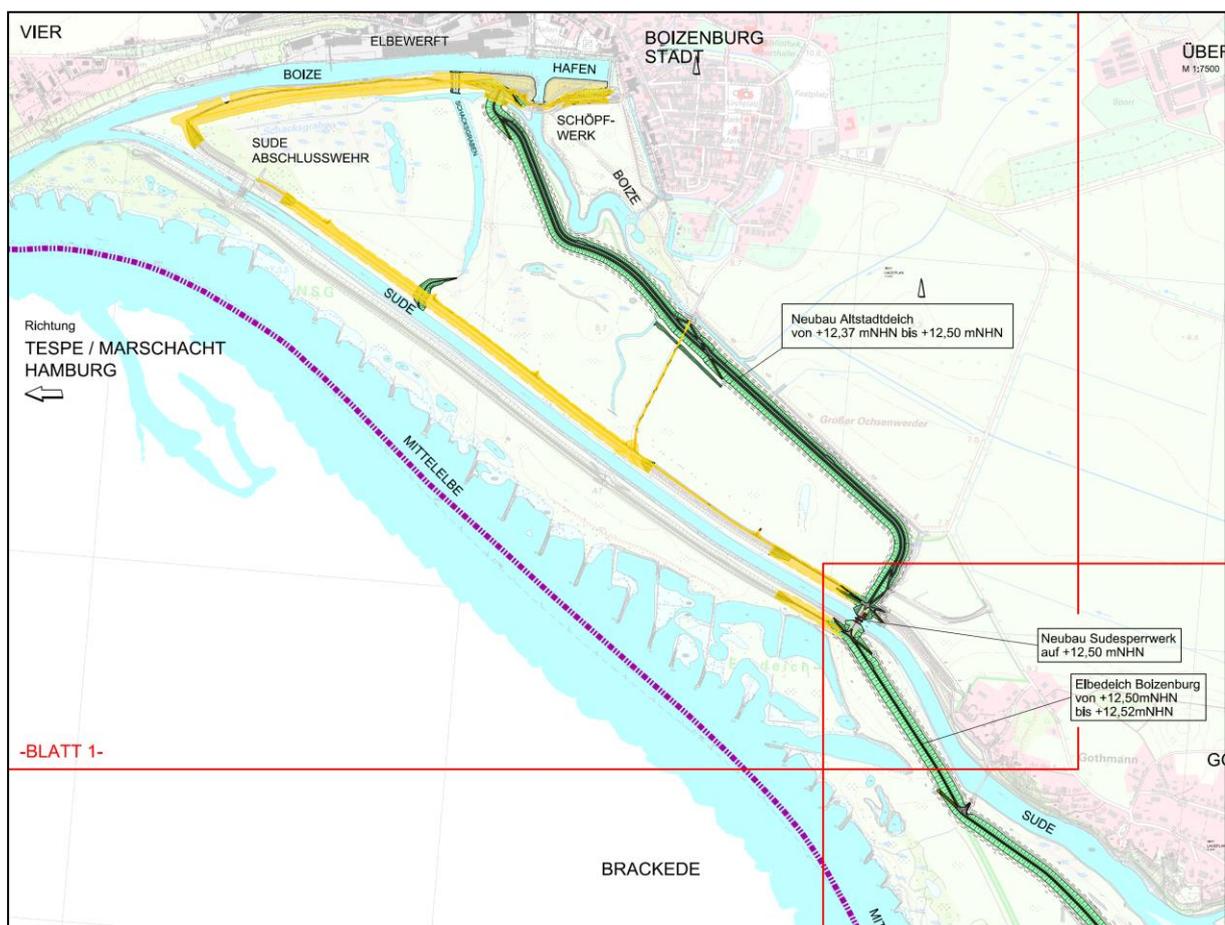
Übersichtslageplan Hochwasserschutz Boizenburg, Planung zum neuen Sperrwerkstandort (Ausschnitt) (Ramboll, Stand: 17.09.2021)
